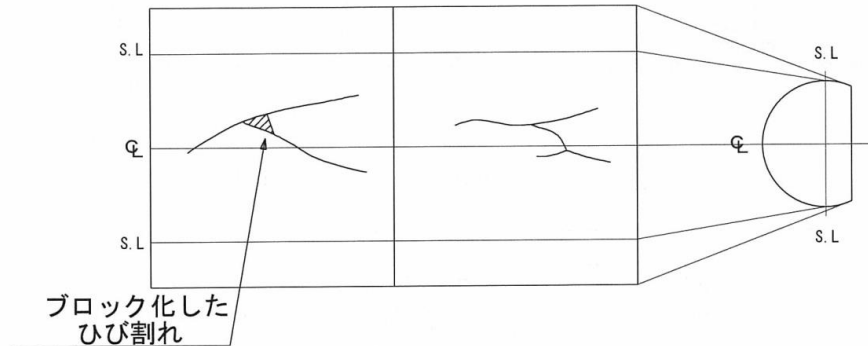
複数のひび割れでブロック化した覆工コンクリートの例 1)
